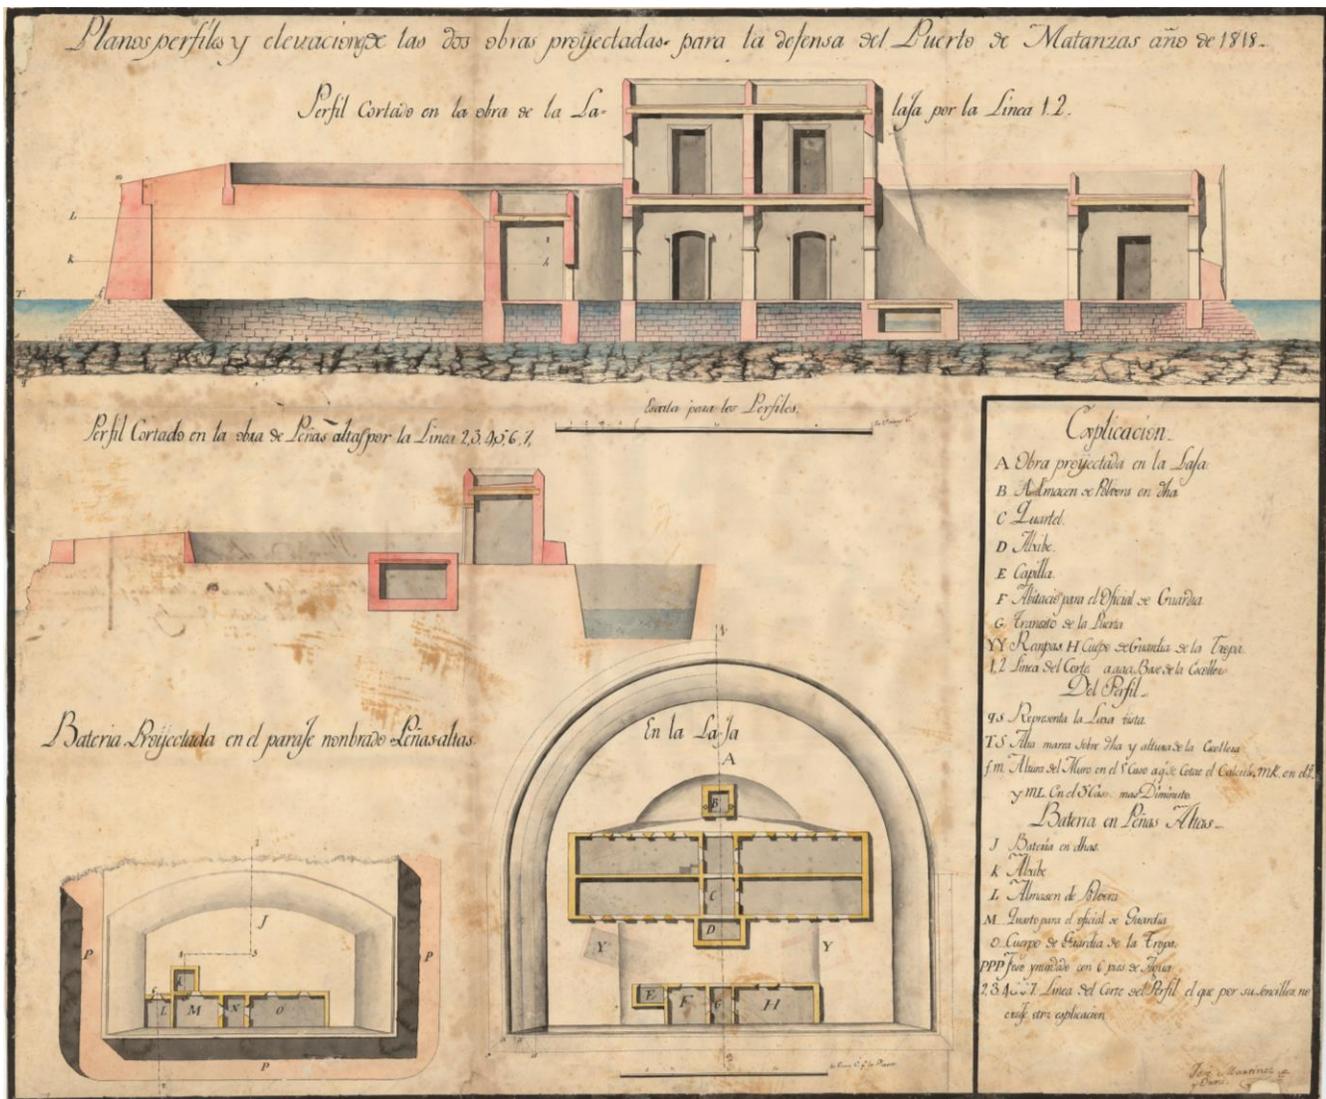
Planos, perfiles y elevaciones de dos obras proyectadas para la defensa del puerto de Matanzas: las baterías de La Laja y Peñas Altas (1818). AGM, CUB-104-18
